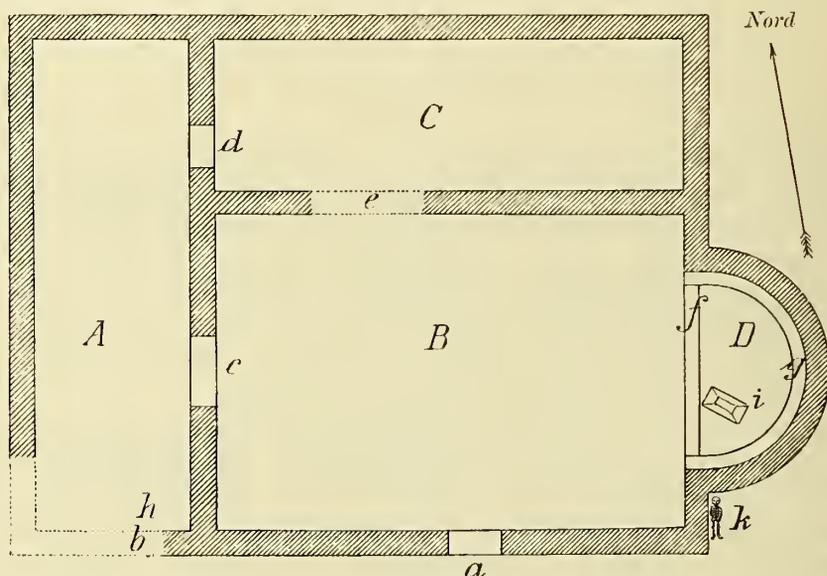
Grundriss eines Gebäudes auf der „Crkvina“ bei Šipraga.
